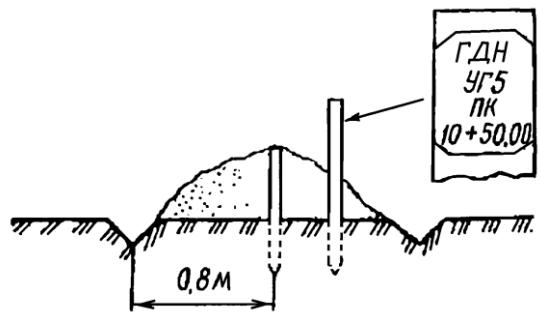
Схема закрепления угла поворота, размещенного за пределами строительных работ
